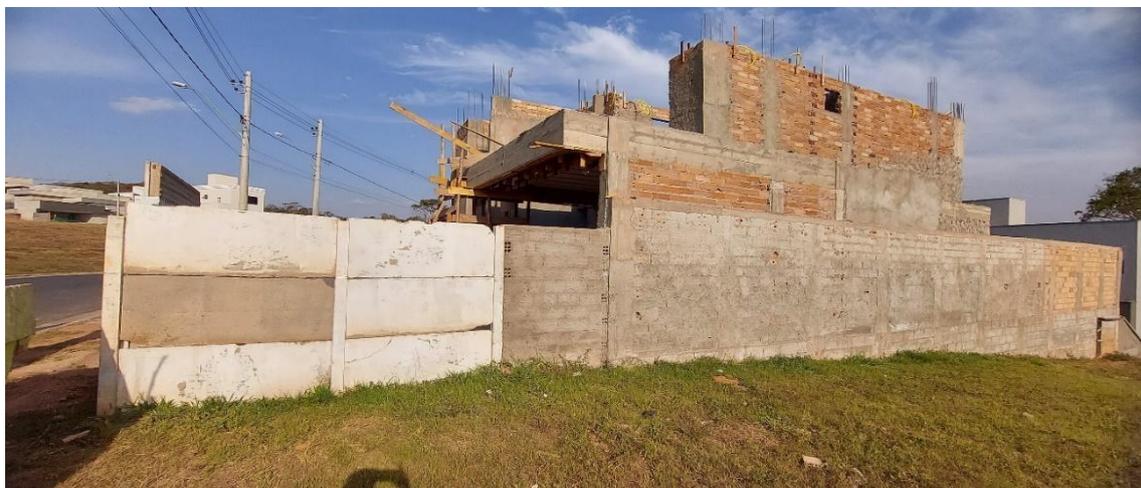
Fachada Obra 1: Sem isolamento da construção.
